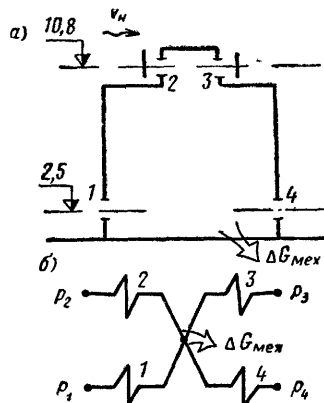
Вертикальный разрез здания (а) и схема связей помещения с наружным воздухом (б) к примеру XVIII.1
